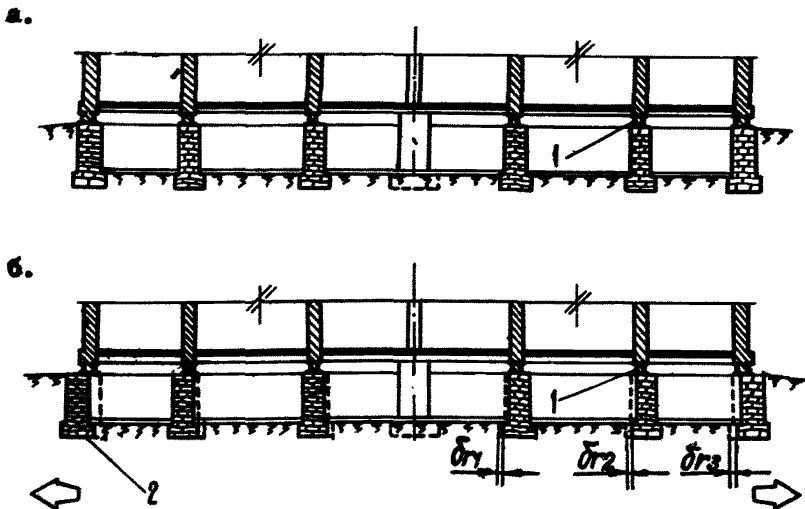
Схема смещения фундаментов торцевых и поперечных стен здания, не усиленного фундаментными поясами:
